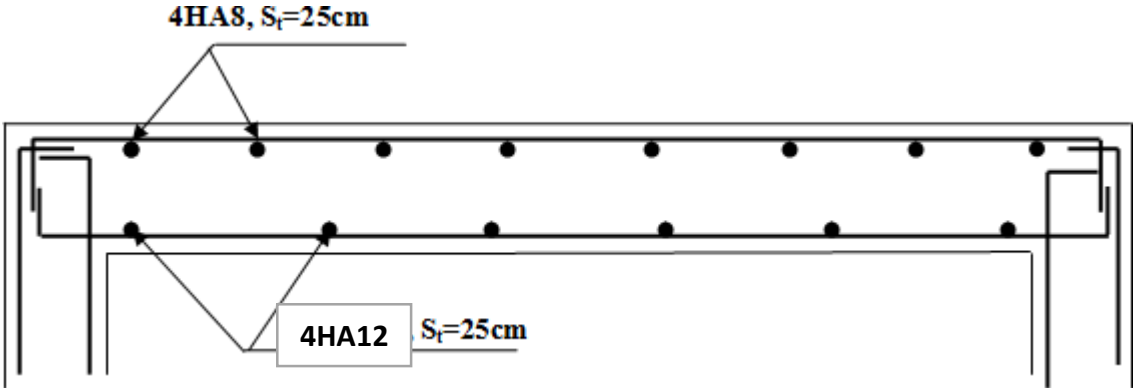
Plan de ferrailage de la salle machine suivant x-x.
